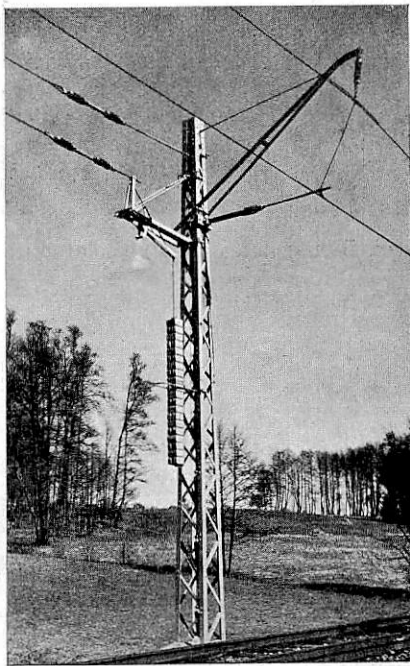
Hebelnachspanner mit Fahrdrabt Bruchsperr Bauart Hannes.
